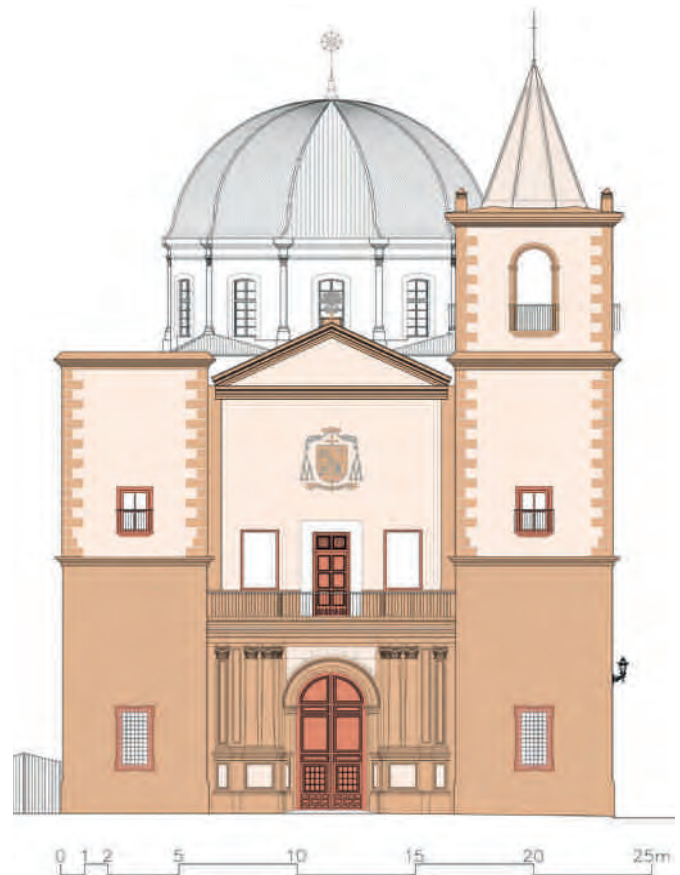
Alzado principal en su fachada norte. Juan de Dios de la Hoz, Lavila Arquitectos.
